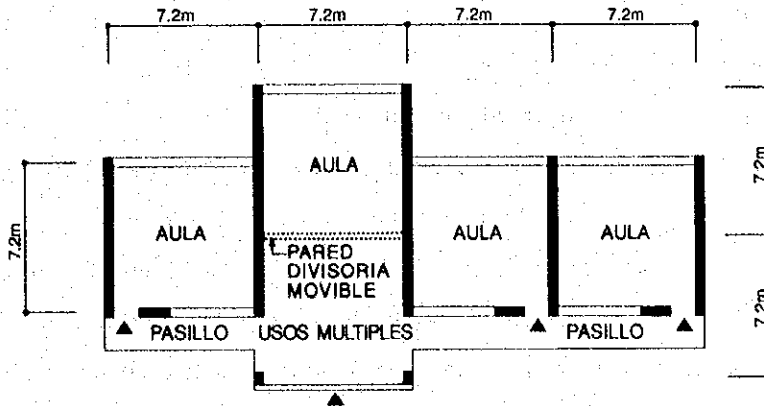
PLANTA DEL EDIFICIO DE AULAS TIPO 4-4-8
